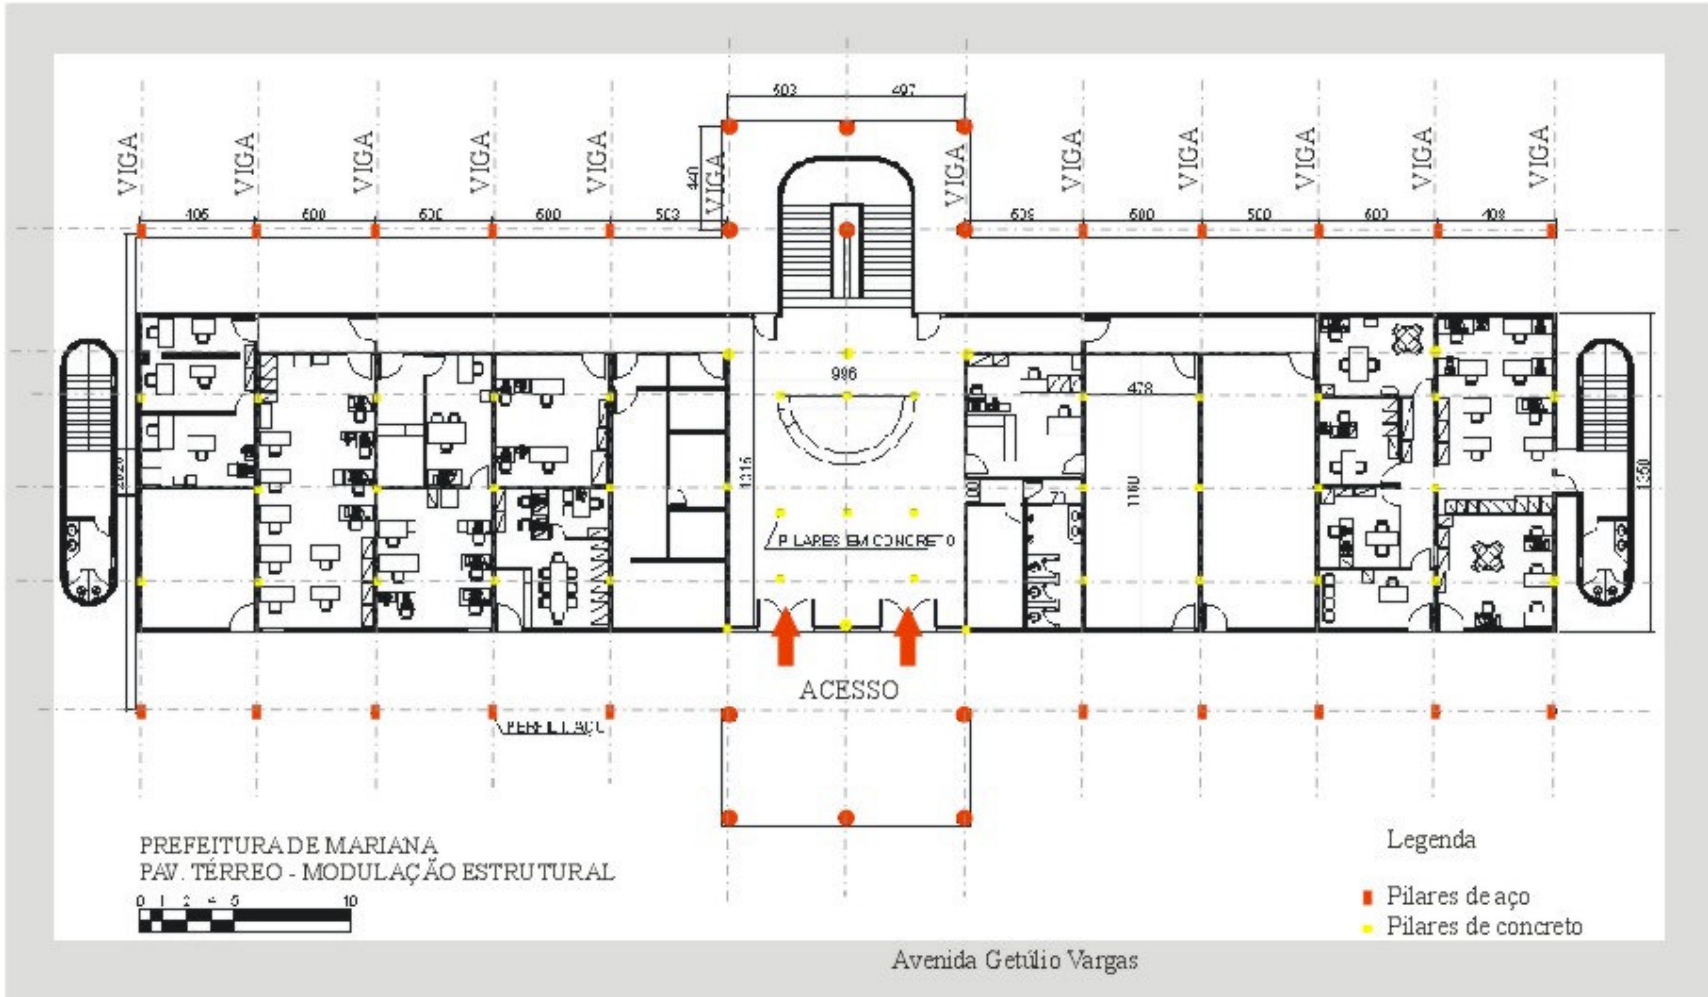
Prefeitura Municipal de Mariana – Pavimento Térreo – Modulação Estrutural.
